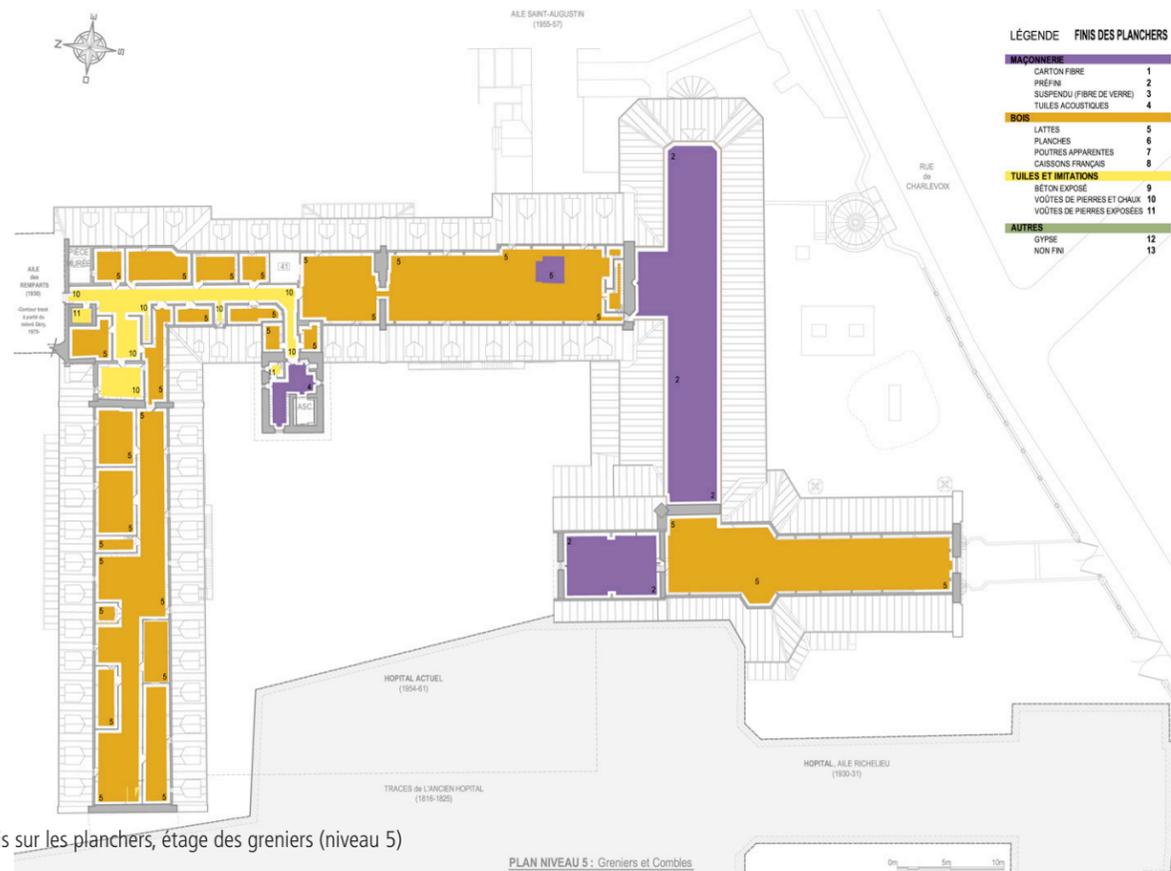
Plan des fins sur les planchers, étage des greniers (niveau 5)
